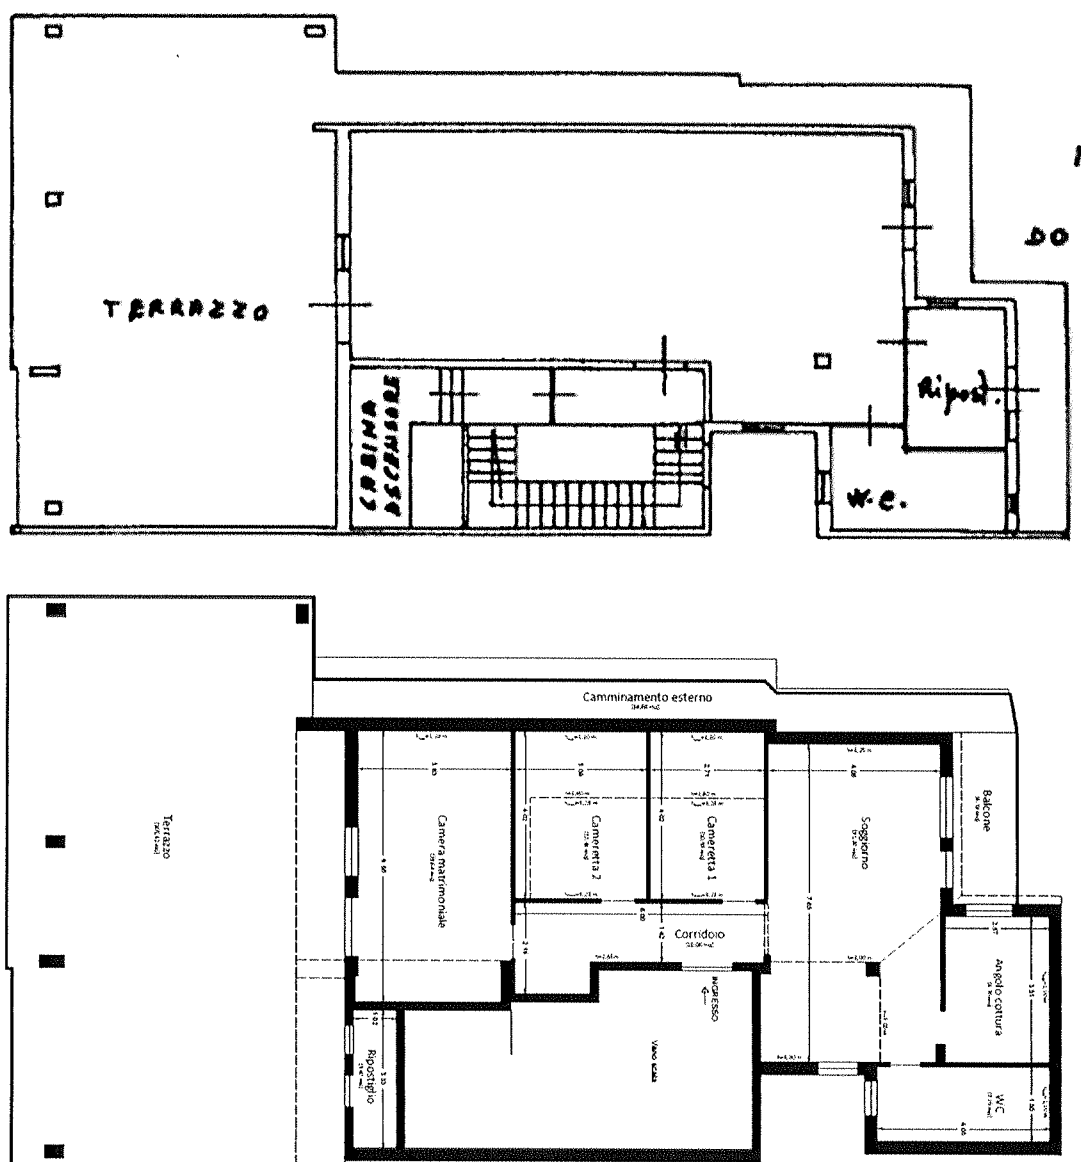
Confronto planimetria stato di fatto e planimetria catastale
